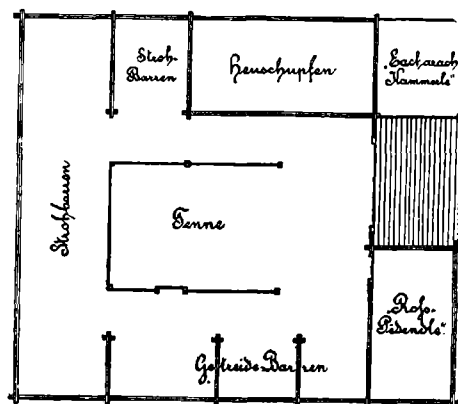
Grundriss des Obergeschosses des Winkler-Stadels.
